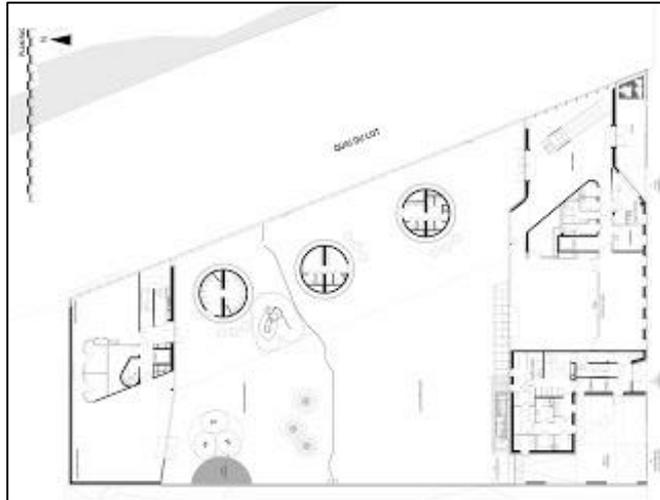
Planta Escuela primaria y guardería en el ZAC "Claude Bernard"
